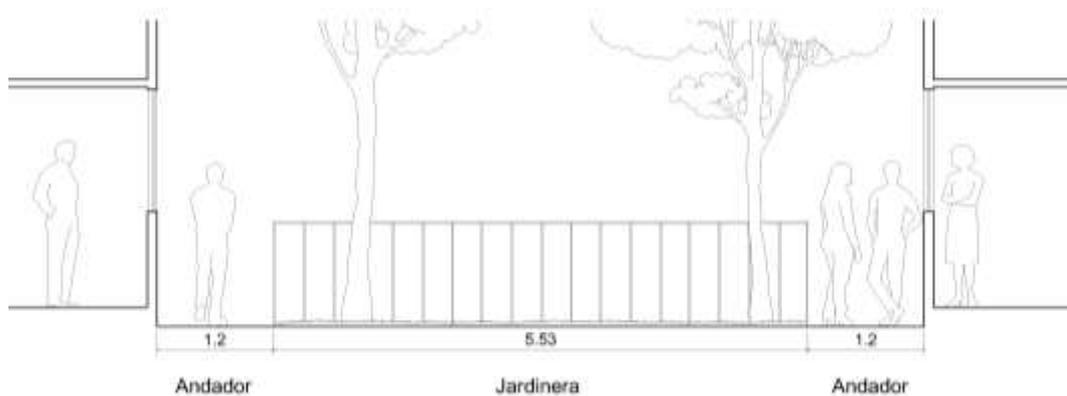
Corte d-d': se muestran los 5.53 metros de jardinera central, los 1.20 metros de cada circulación exterior y la cercanía del viandante con el morador de los departamentos en planta baja.
